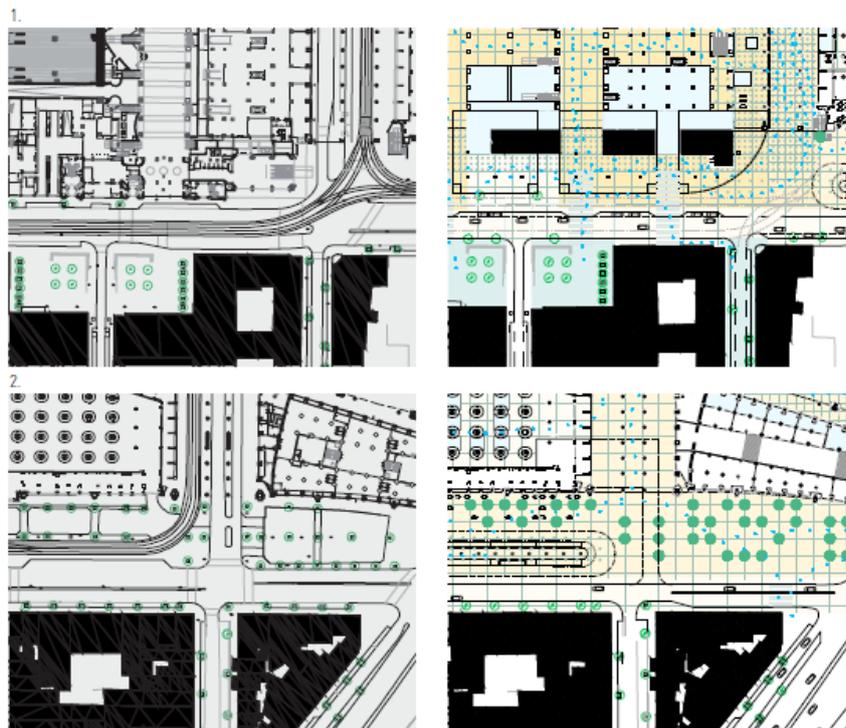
Vue en plan de l'Avenue Fonsny : situation actuelle (gauche) – situation projetée (droite)
